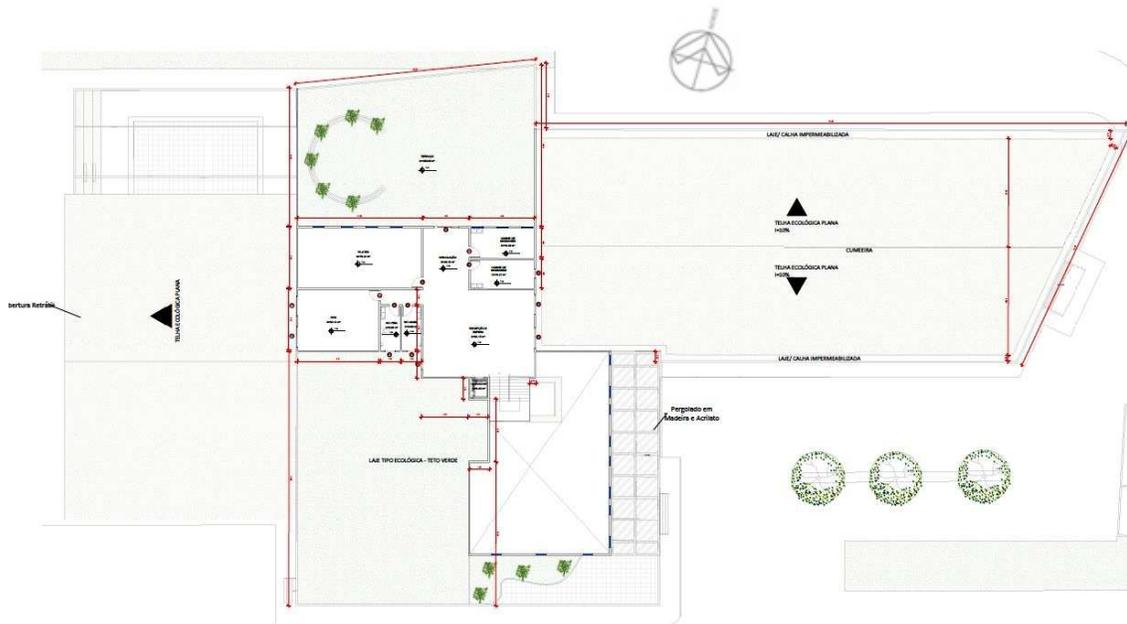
Academia Wellness: Saúde & Lazer - Pavimento 02. Fonte: O Autor
